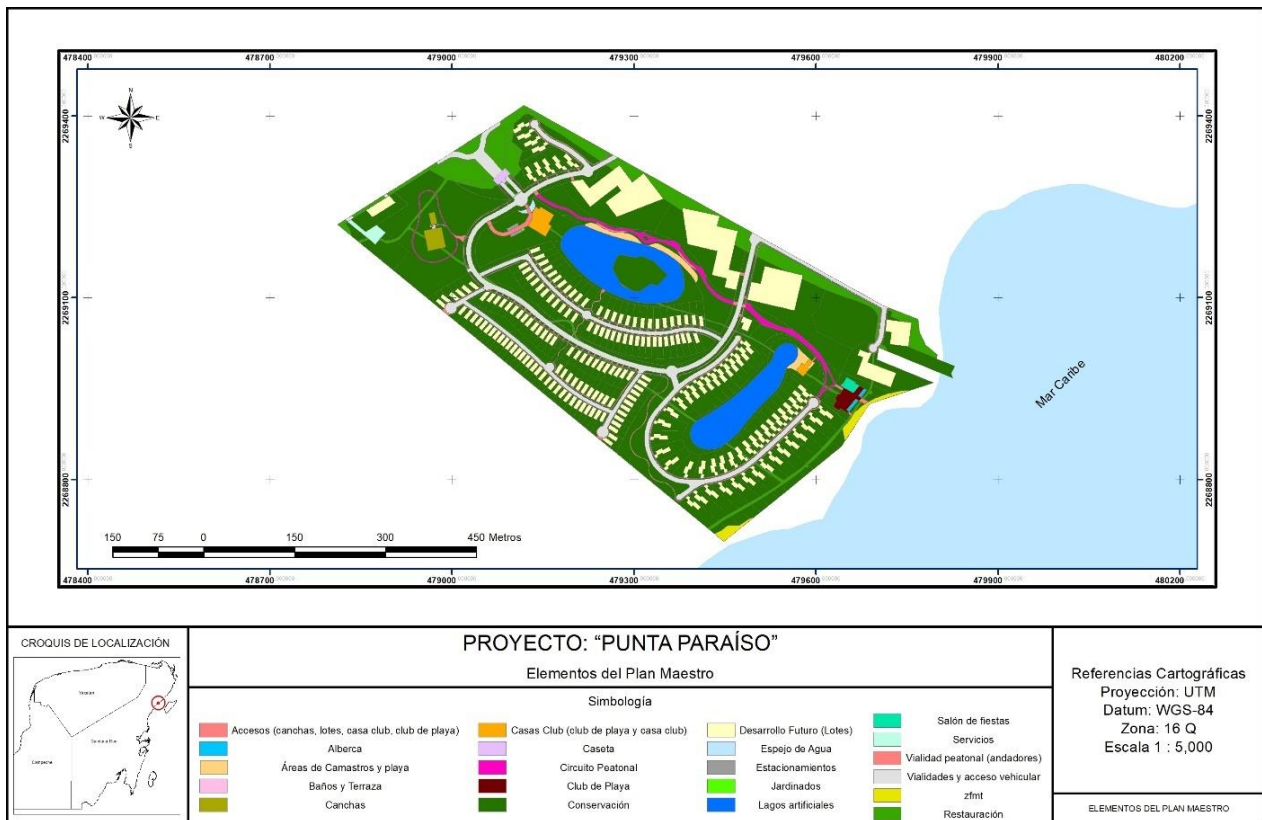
Elementos del plan maestro en su fase final del Proyecto “Punta Paraíso”.
